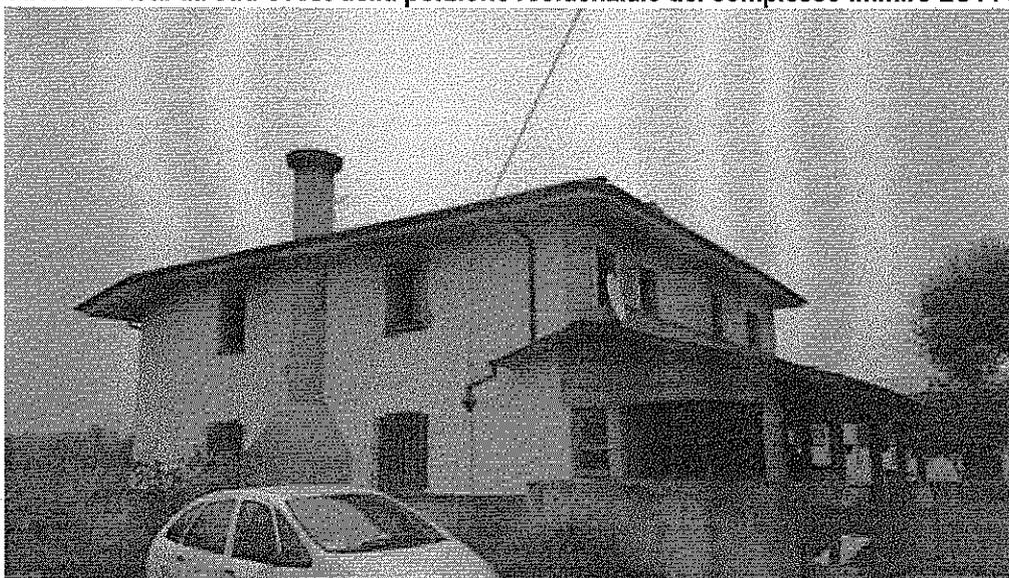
vista da sud della porzione residenziale del complesso imm.re LOTTO N. 1
